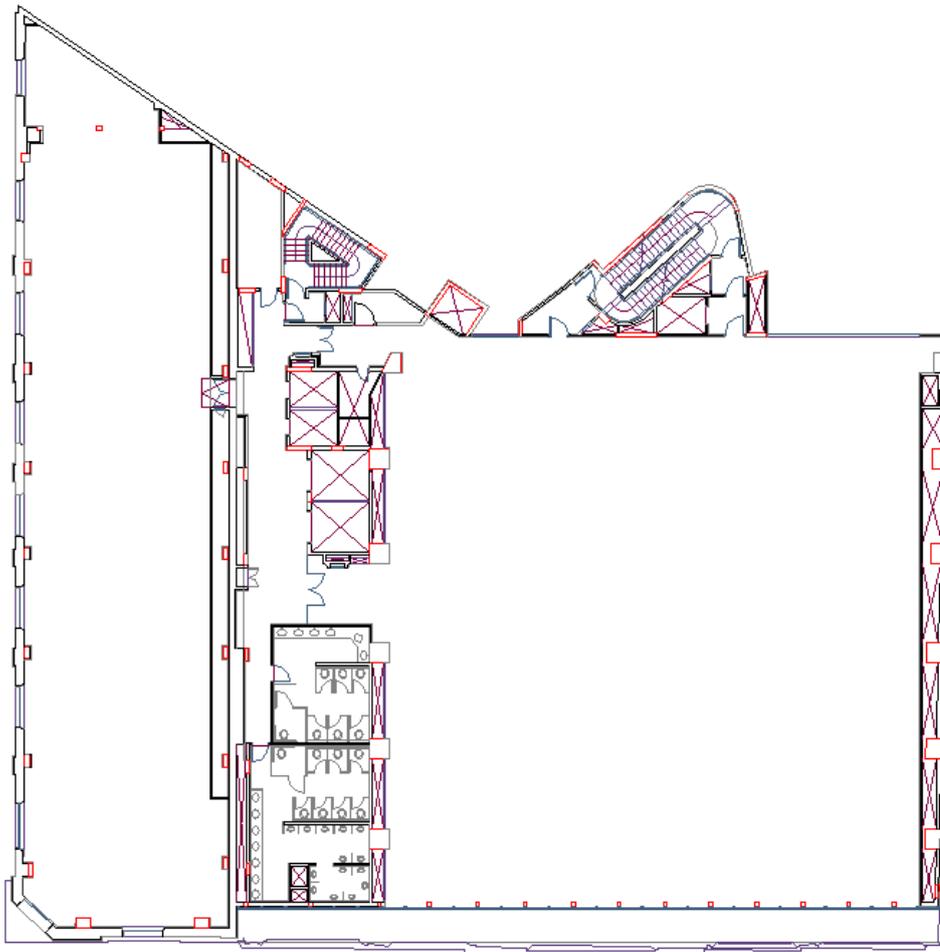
Planta do 6º pavimento atual. Prevaleceu o conceito de núcleo de serviços e acessos, nas periferias as escadas e *shafts* de sistemas prediais adicionais. Projeto: Julio Neves Arquitetos
